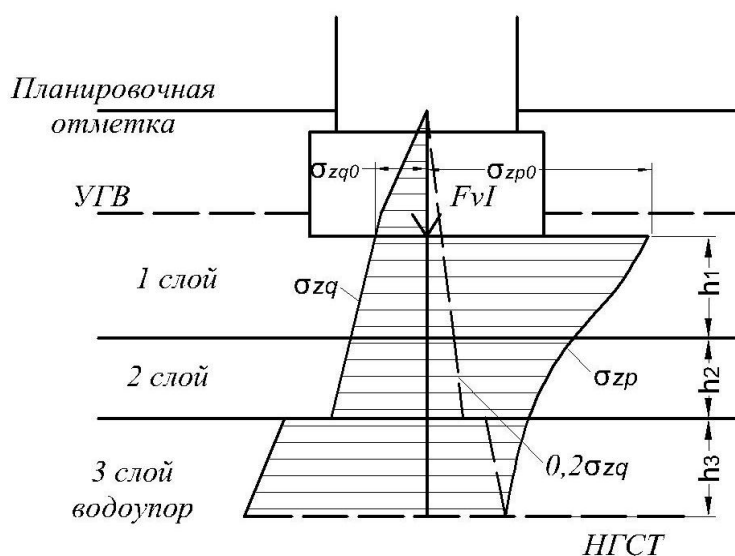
Расчетная схема для определения осадки фундамента мостовой опоры на суходоле
